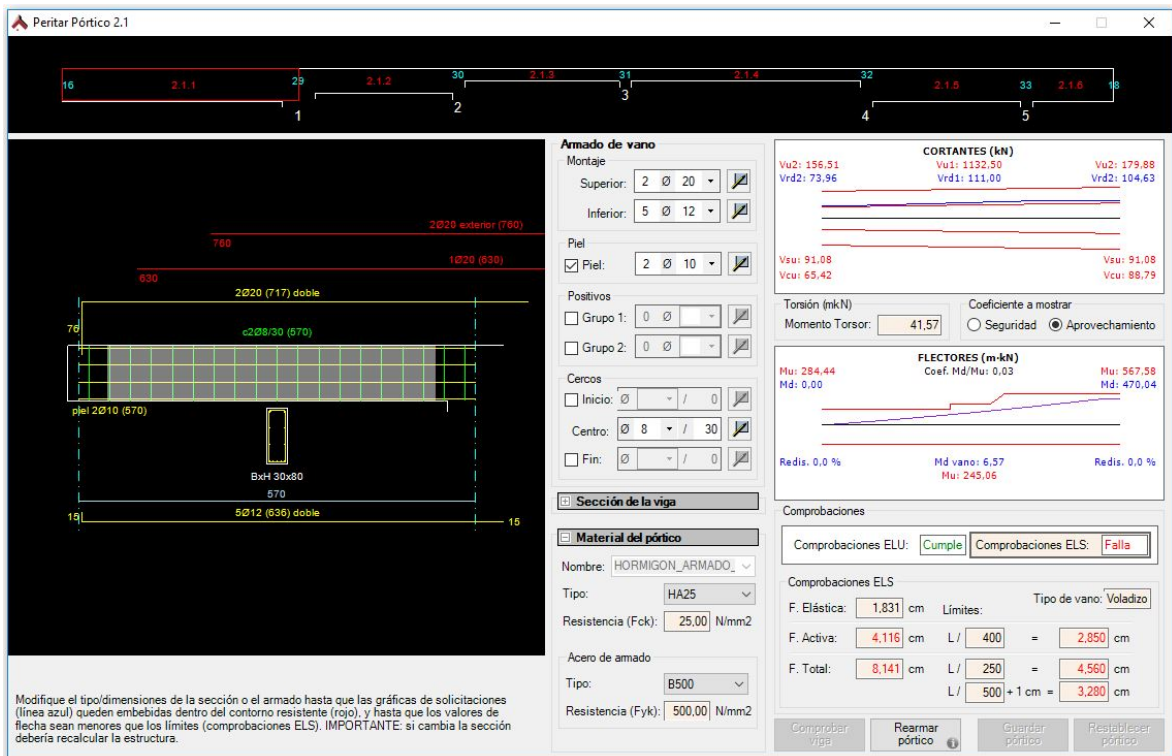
Peritación vigas – Material del pórtico y ELS
